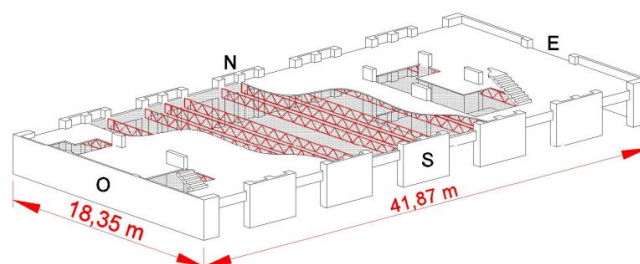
Corte en isométrico de la torre, planta tipo (Aguilar, 2016).
